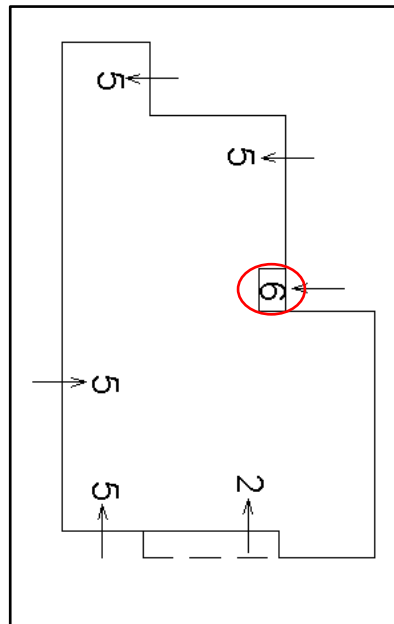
Estratto dell'elaborato planimetrico, piano terra
